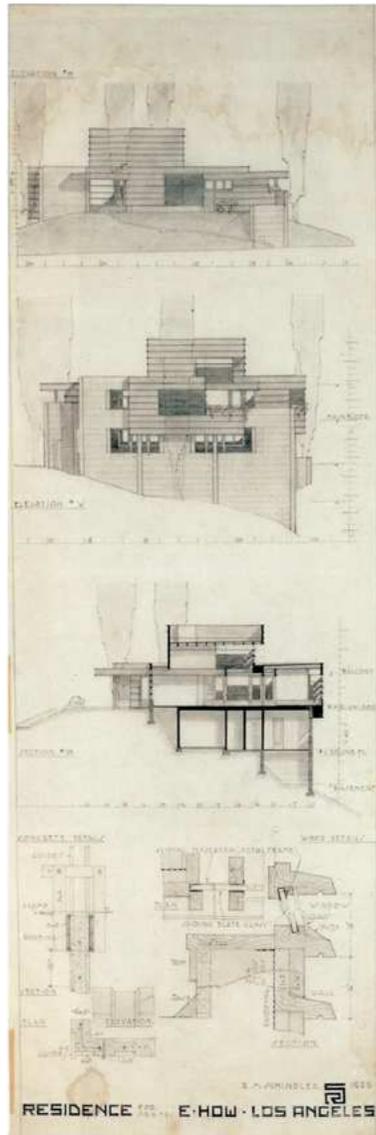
, Originalzeichnung R. M. Schindler, How Haus
